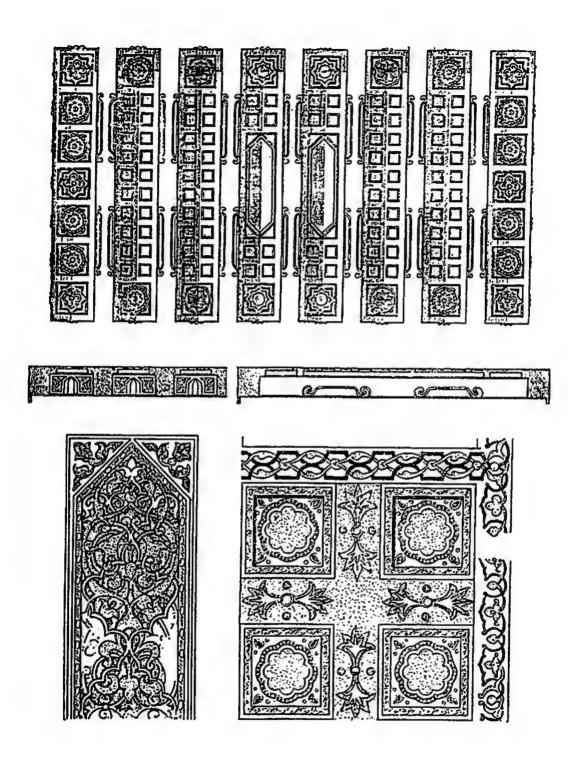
مسقط أفقى لأرضية رخام عددخل محل (تصميم المؤلف)
